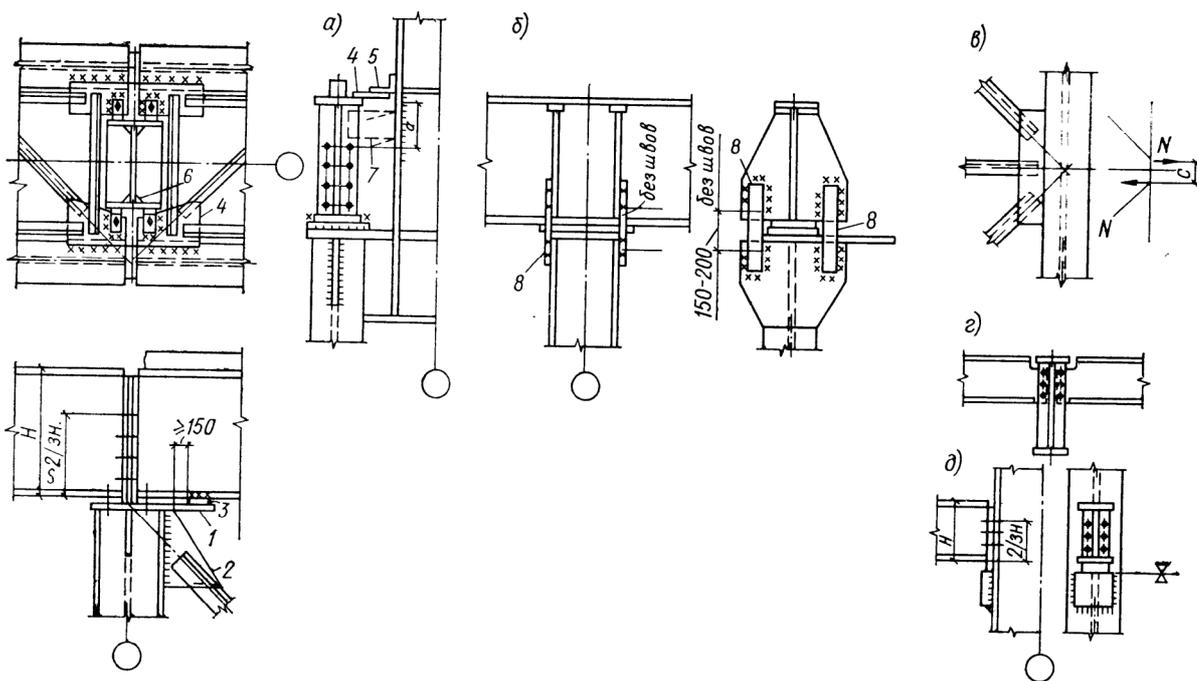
Обеспечение соответствия расчетной и конструктивной схем подкрановых балок и балок междуэтажных перекрытий
